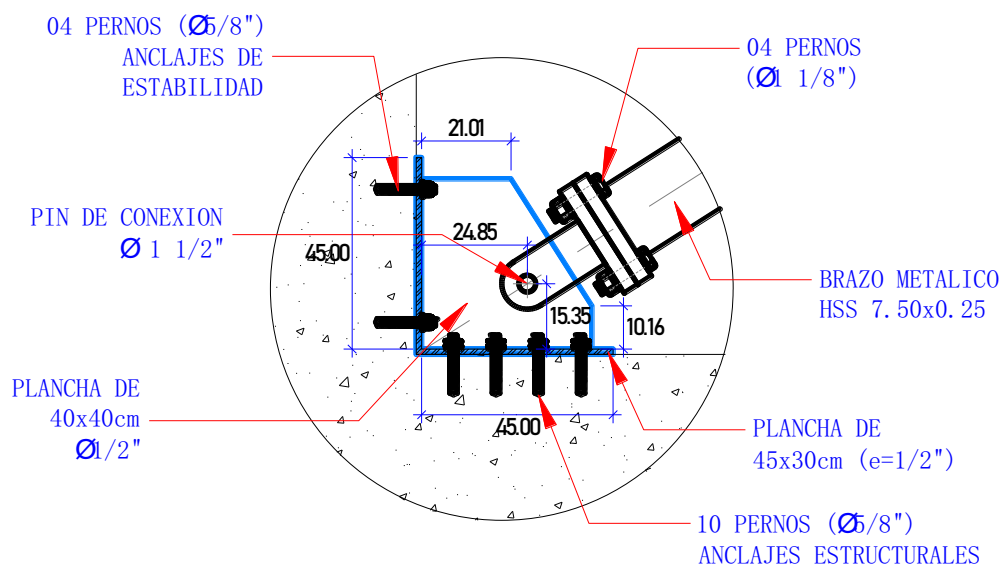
Detalle 1 (Conexión brazo metálico – Cartela - Estructura de concreto)
